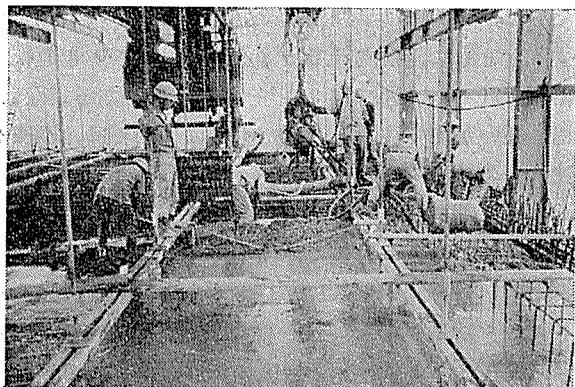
コンクリート打設中 (ゲリュースト ワーゲン)
